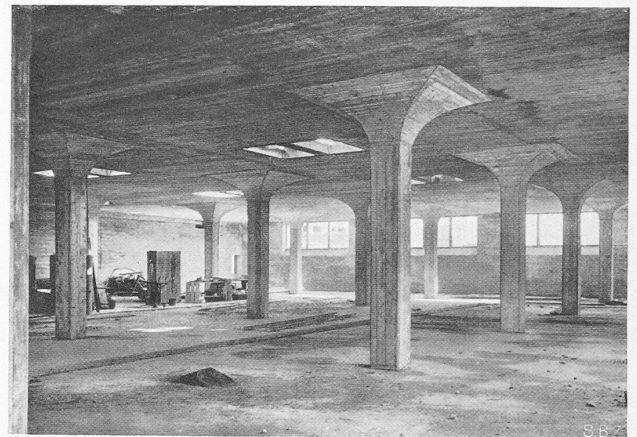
Pilldecke im Anbau-Untergeschoss (Sackstückversand).
